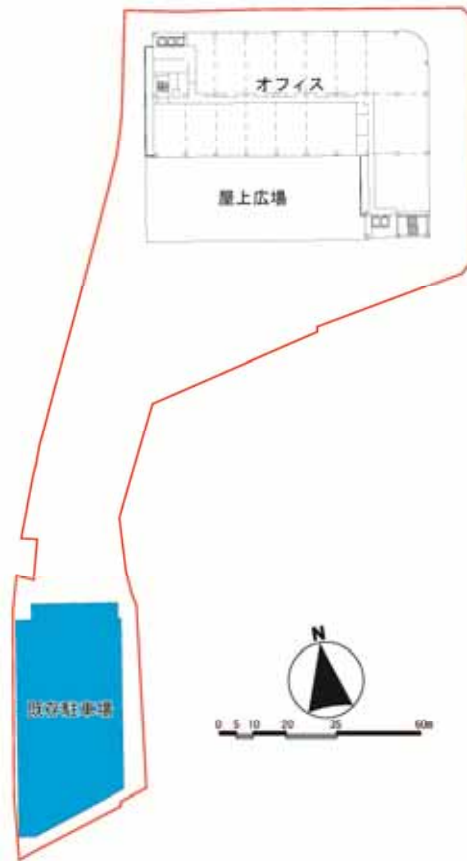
(10) 各階平面図 ( 10 ~ 12 F )
